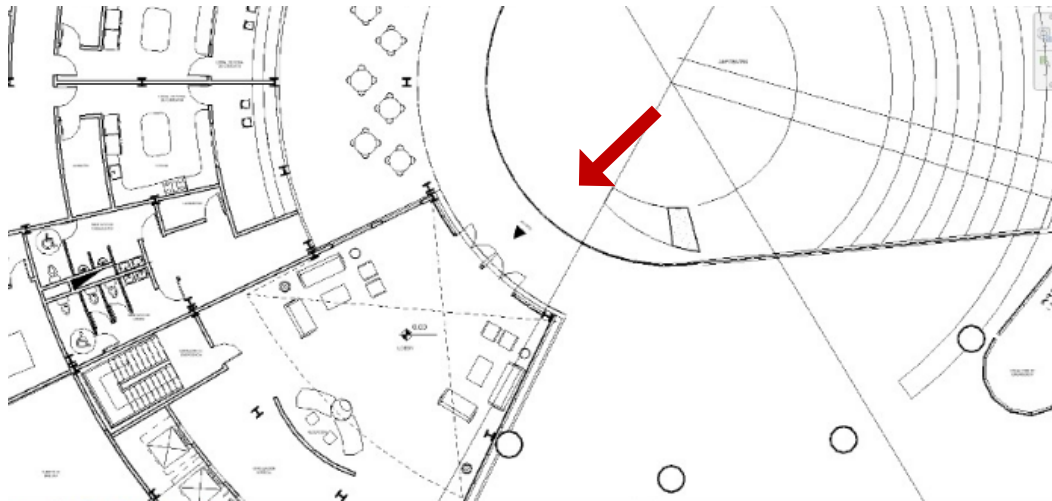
Plano de señalización de acceso de peatonal. Fuente: Plano Planta Baja (2019)
